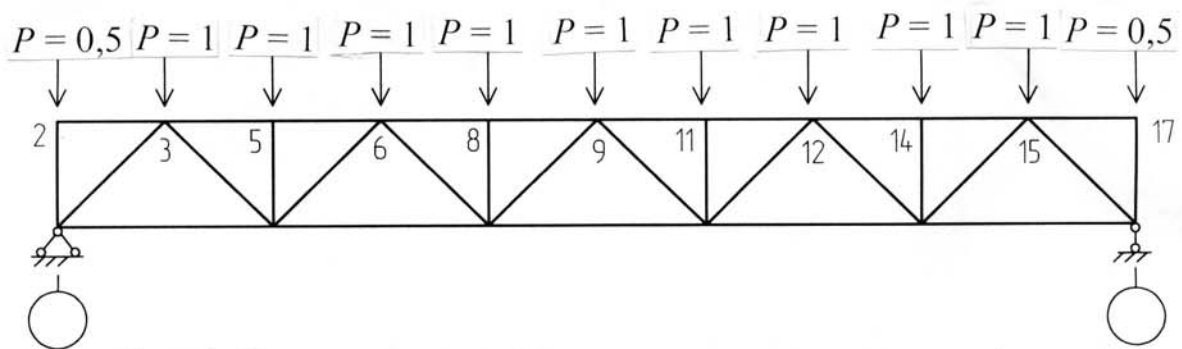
Схема приложения вертикальных нагрузок на ферму
